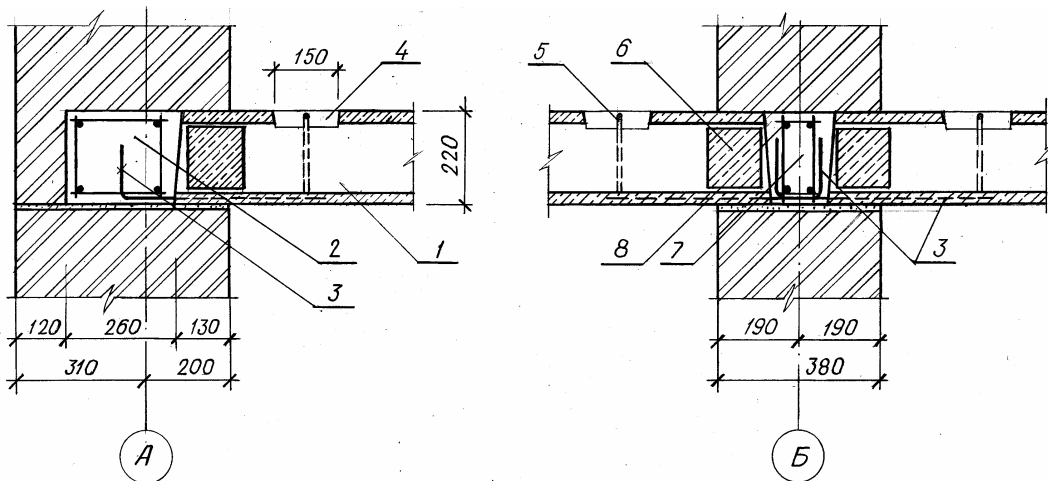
Вузли обтирання круглопорожнистих плит перекриттів на несучі стіни:
